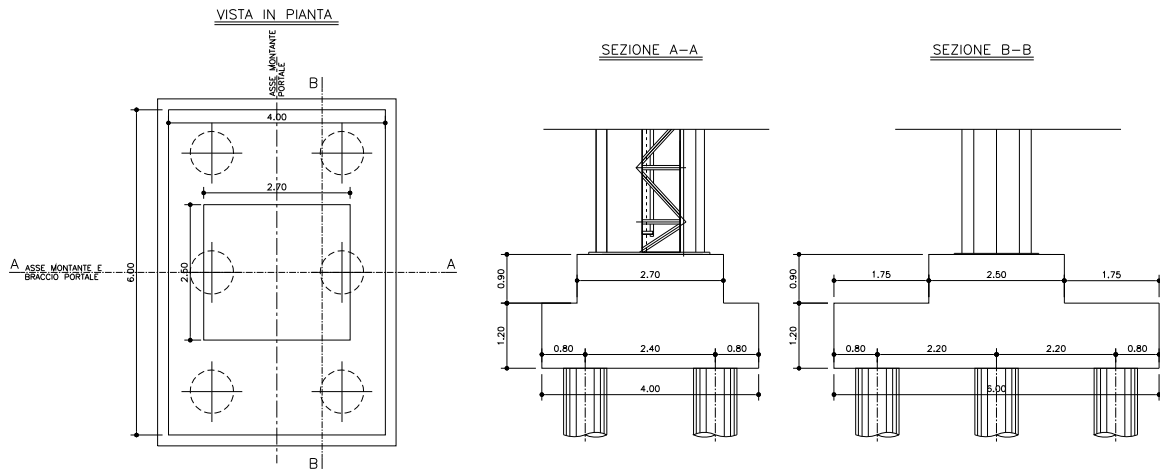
Pianta e Sezione Fondazioni portale PMV
